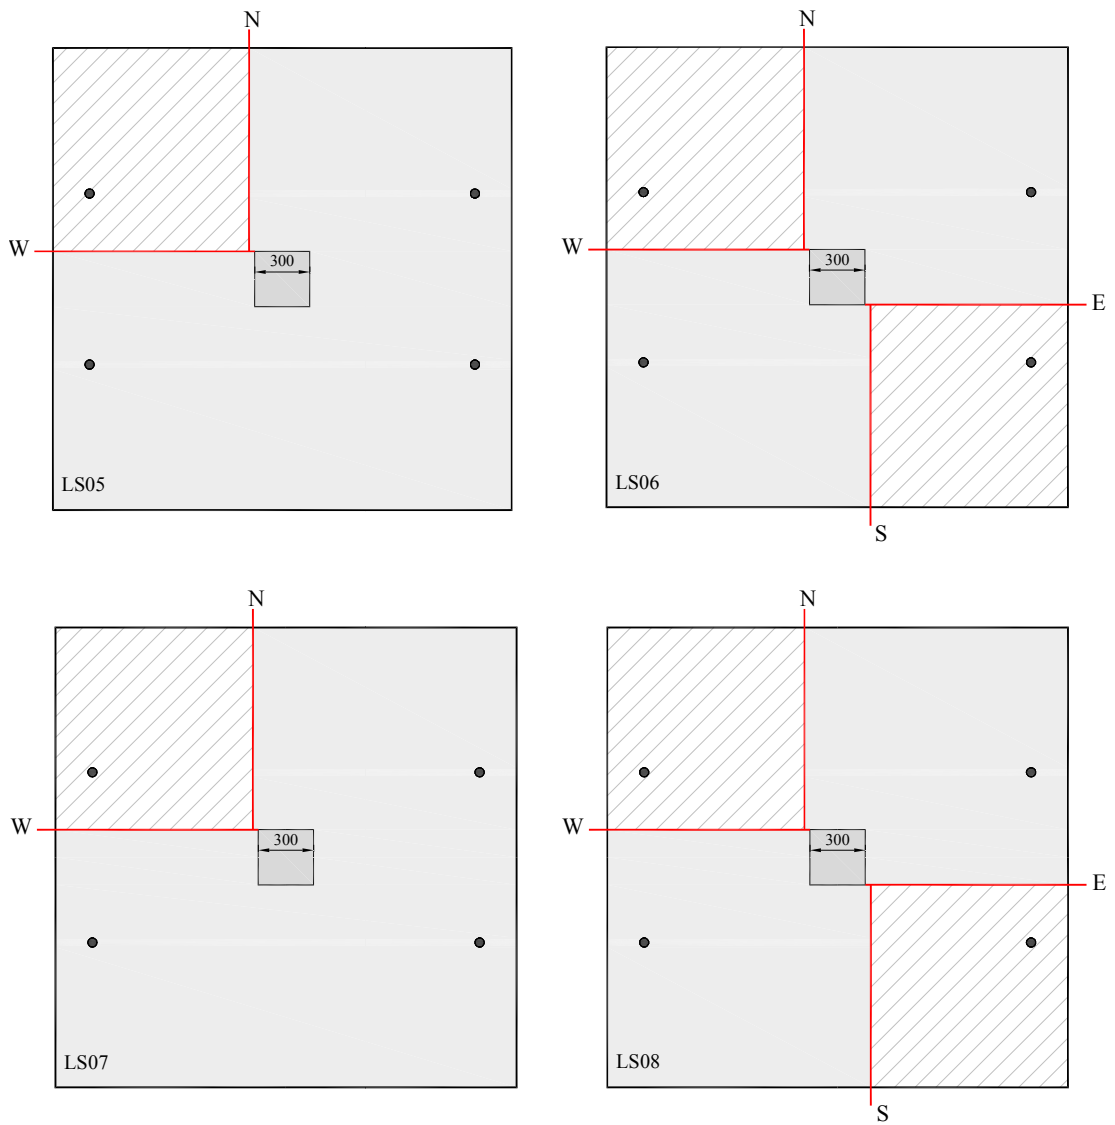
Plano de corte das lajes LS05 à LS08
